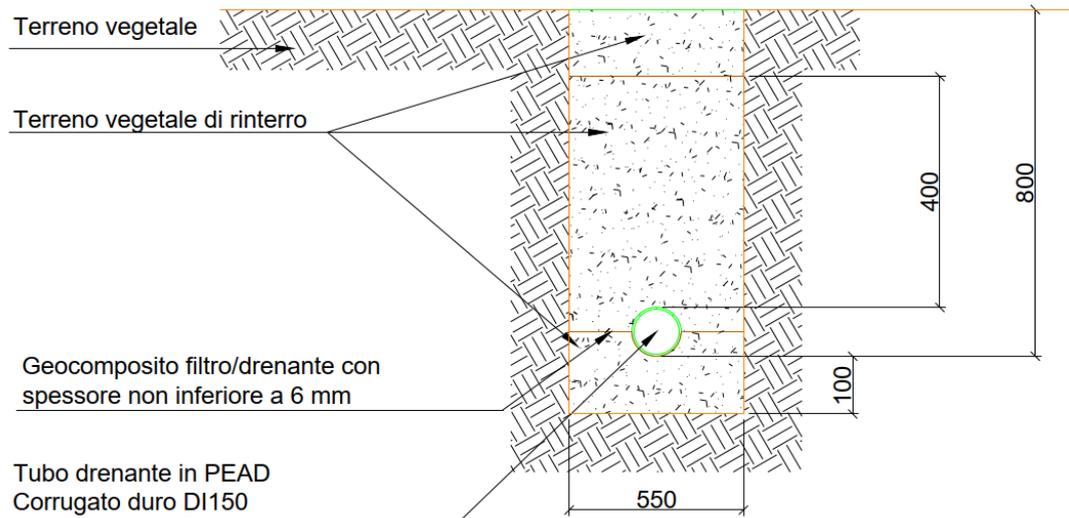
Sezione trincea drenante con tubazione DI 150 e riempimento dello scavo con terreno vegetale
